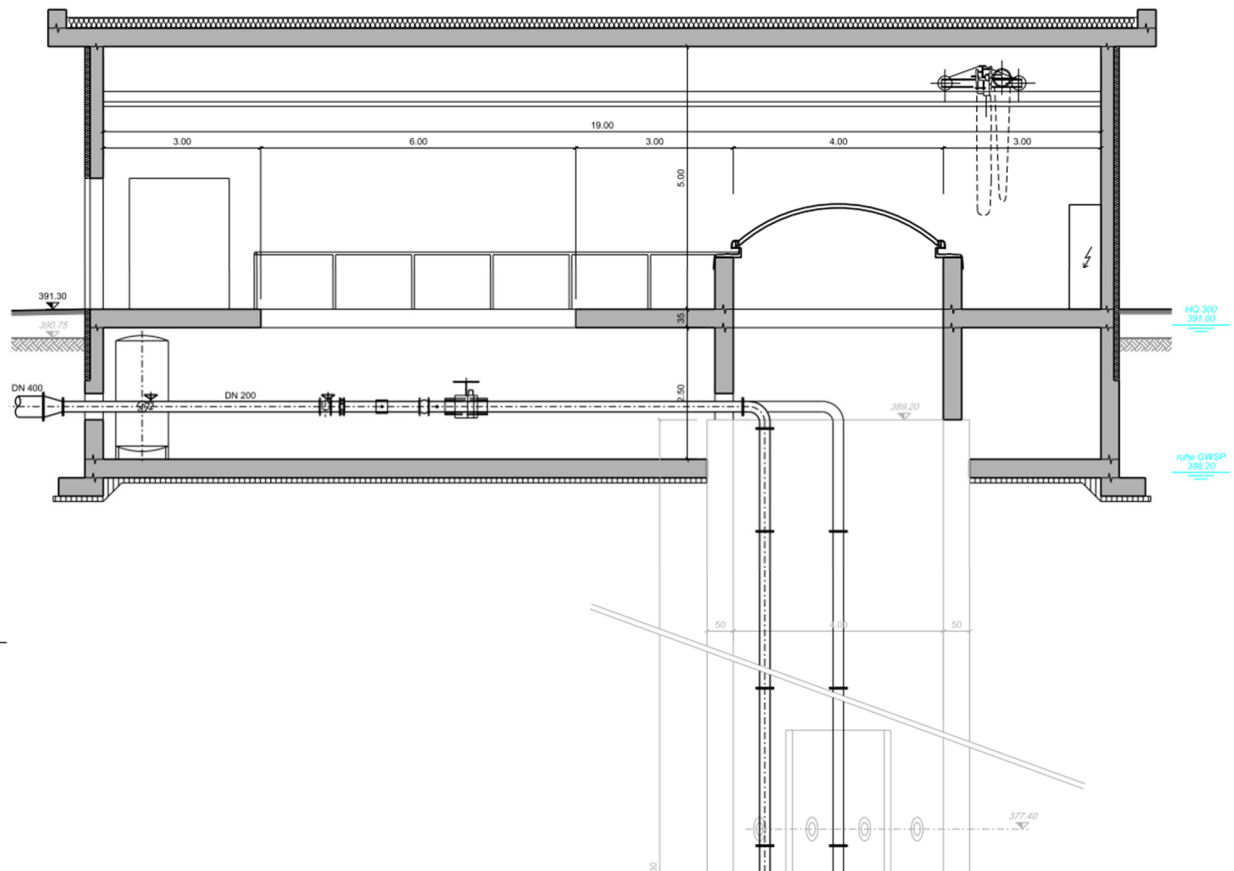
Verkleinerter Ausschnitt aus dem Plan [13]
